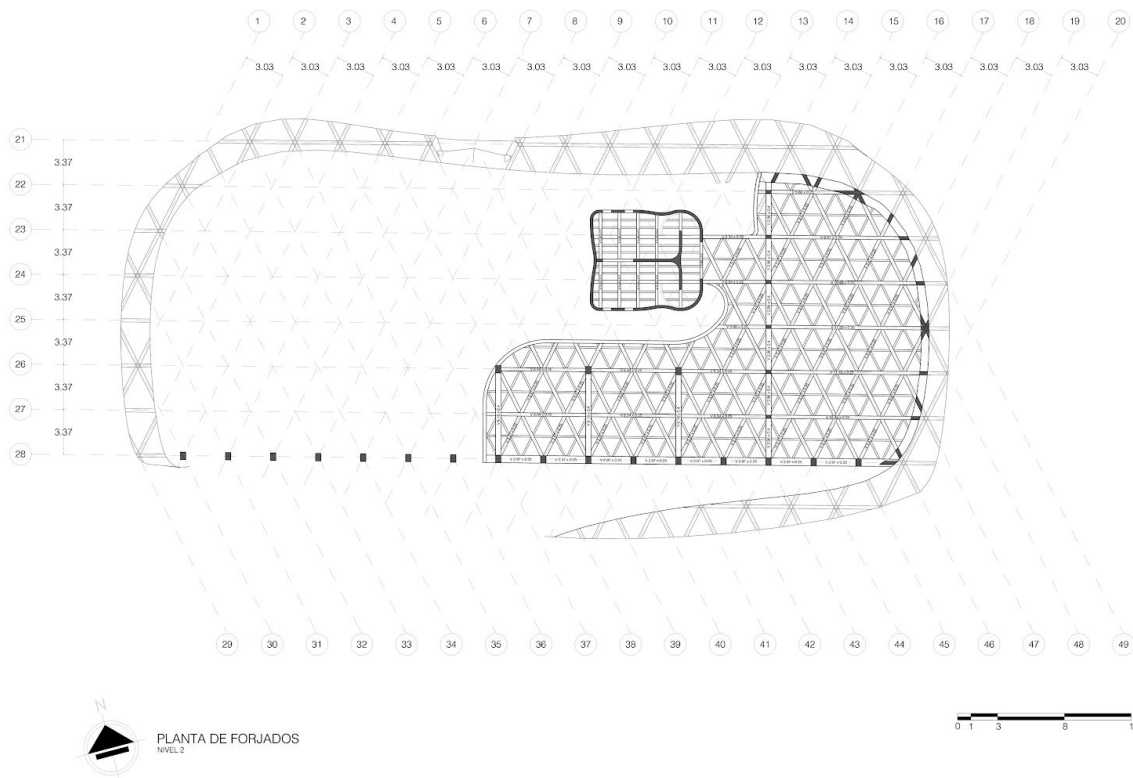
Plano estructural de forjados - segundo nivel. Elaboración propia.
